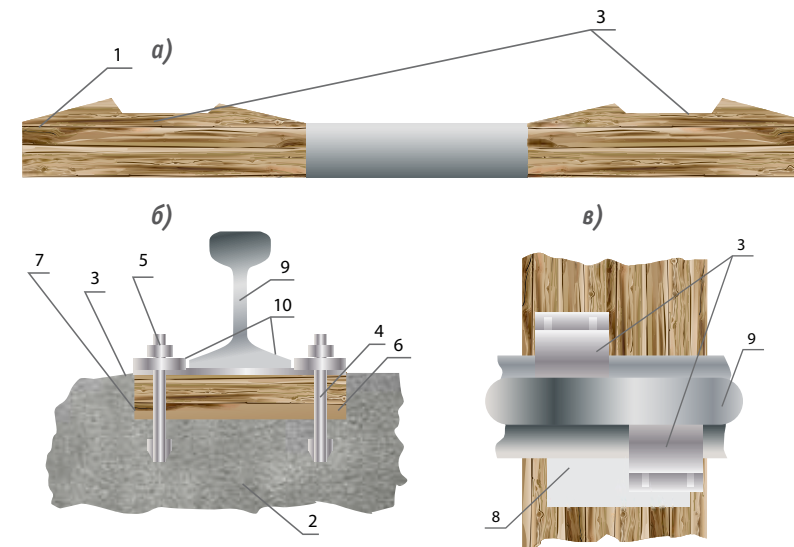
Конструкция шпалы, разработанная в СПбГЛТУ: а – шпала, вид спереди; б – фрагмент шпалы с закрепленным на ней рельсом железнодорожного пути; в – то же, вид сверху; 1 – шпала; 2 – железобетонное тело; 3 – опорные площадки; 4 – пустотные каналы; 5 – закладные болты крепления; 6 – демпфирующие элементы; 7 – пазы; 8 – металлические пластины; 9 – рельсы; 10 – накладные пластины
